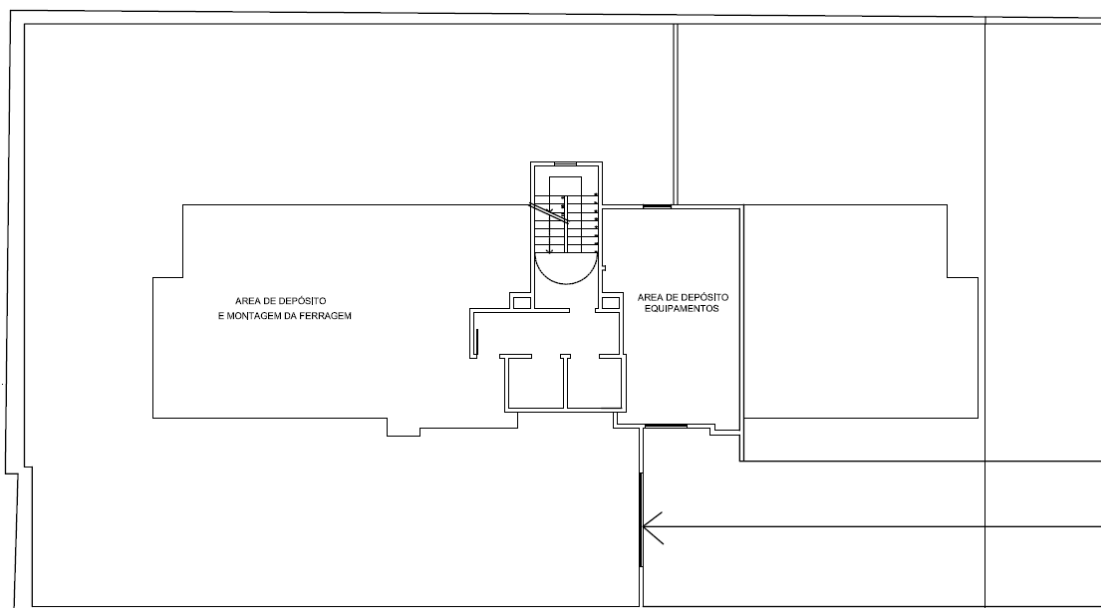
Croqui do canteiro de obra projetado no segundo pavimento
